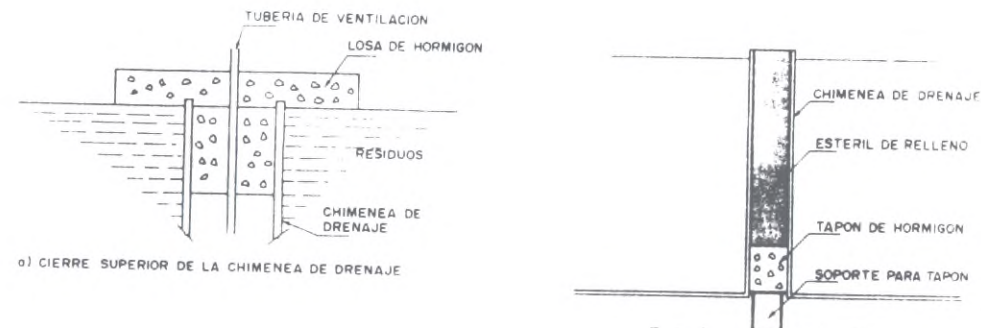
Sistemas de cierre de las chimeneas de drenaje
